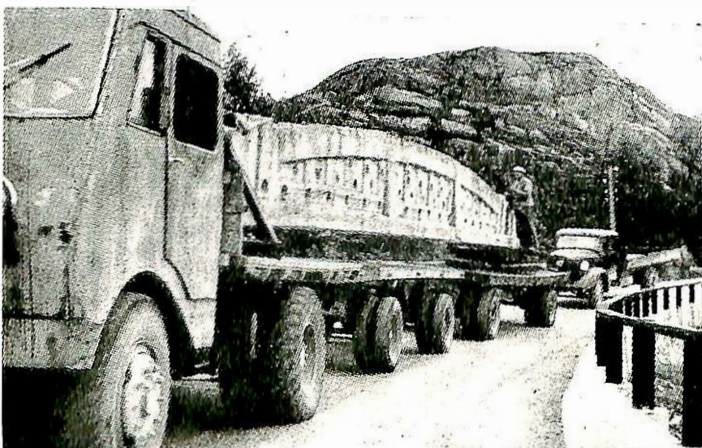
Transport av betongdragere fra lageret til brustedet.
